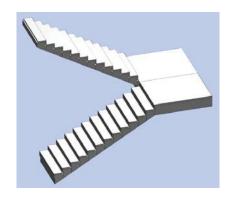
Bauteilmaße und Lastabtragung der Treppenkonstruktion im Regelgeschoss
